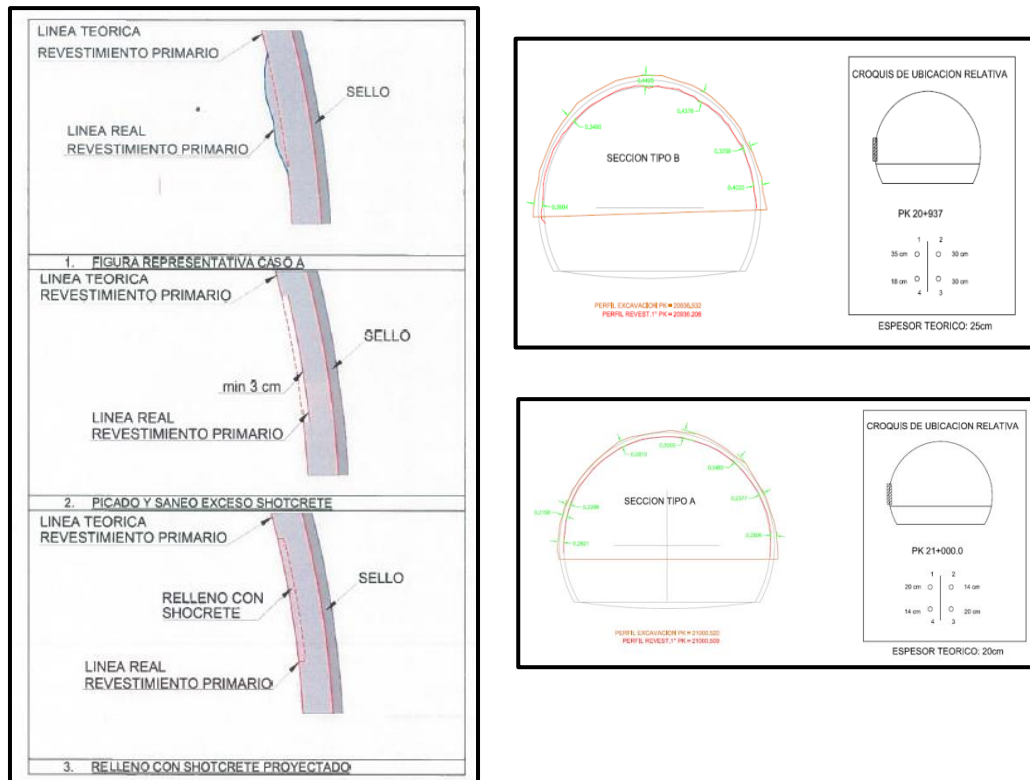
Explicación y levantamiento topográfico a las secciones construidas en el proyecto para verificar la observación.
